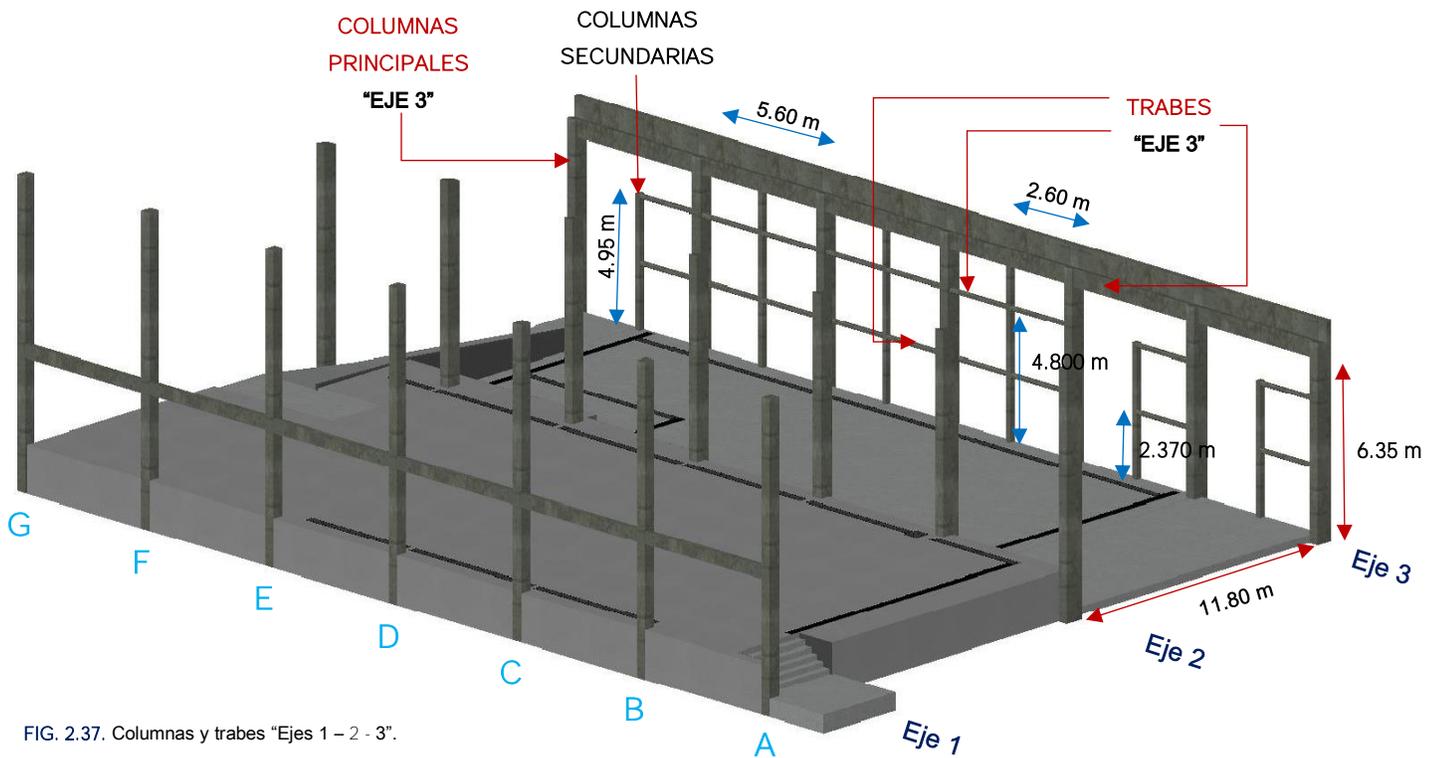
Columnas y traveses "Ejes 1 - 2 - 3".
